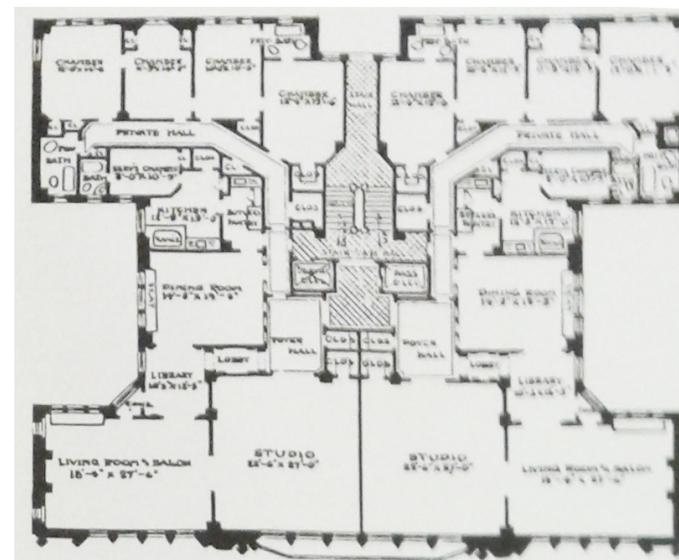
Planta tipo de un edificio de apartamentos-estudio de 1909. Fuente: *New York 1900: metropolitan architecture and urbanism, 1890-1915, 1983
